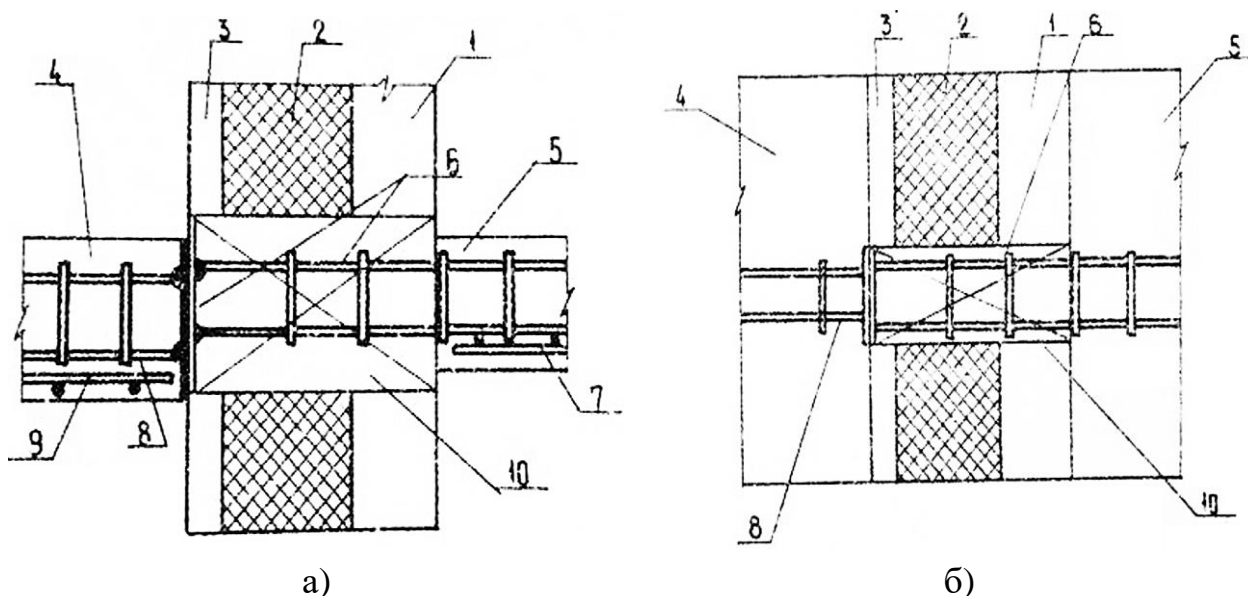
Сопряжение монолитной плиты перекрытия лоджии с наружной стеной и плитой междуэтажного перекрытия. а) поперечный разрез, б) план;
